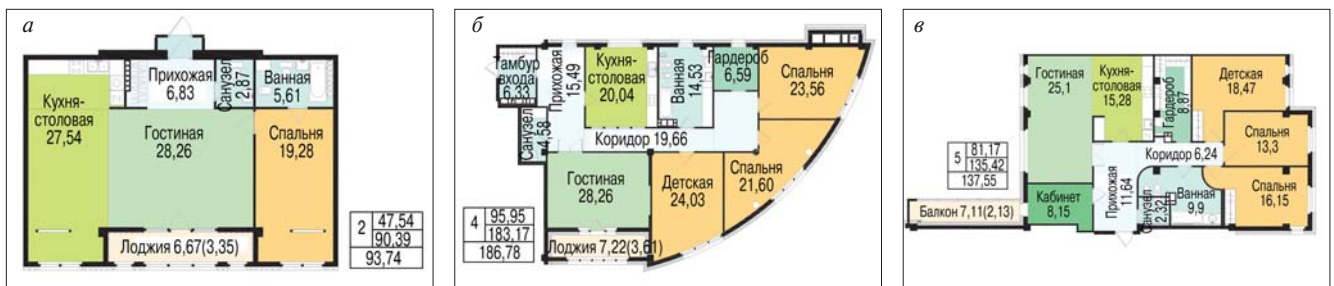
Типовые планировки квартир: а – 2-комнатная; б – 4-комнатная; в – 5-комнатная
